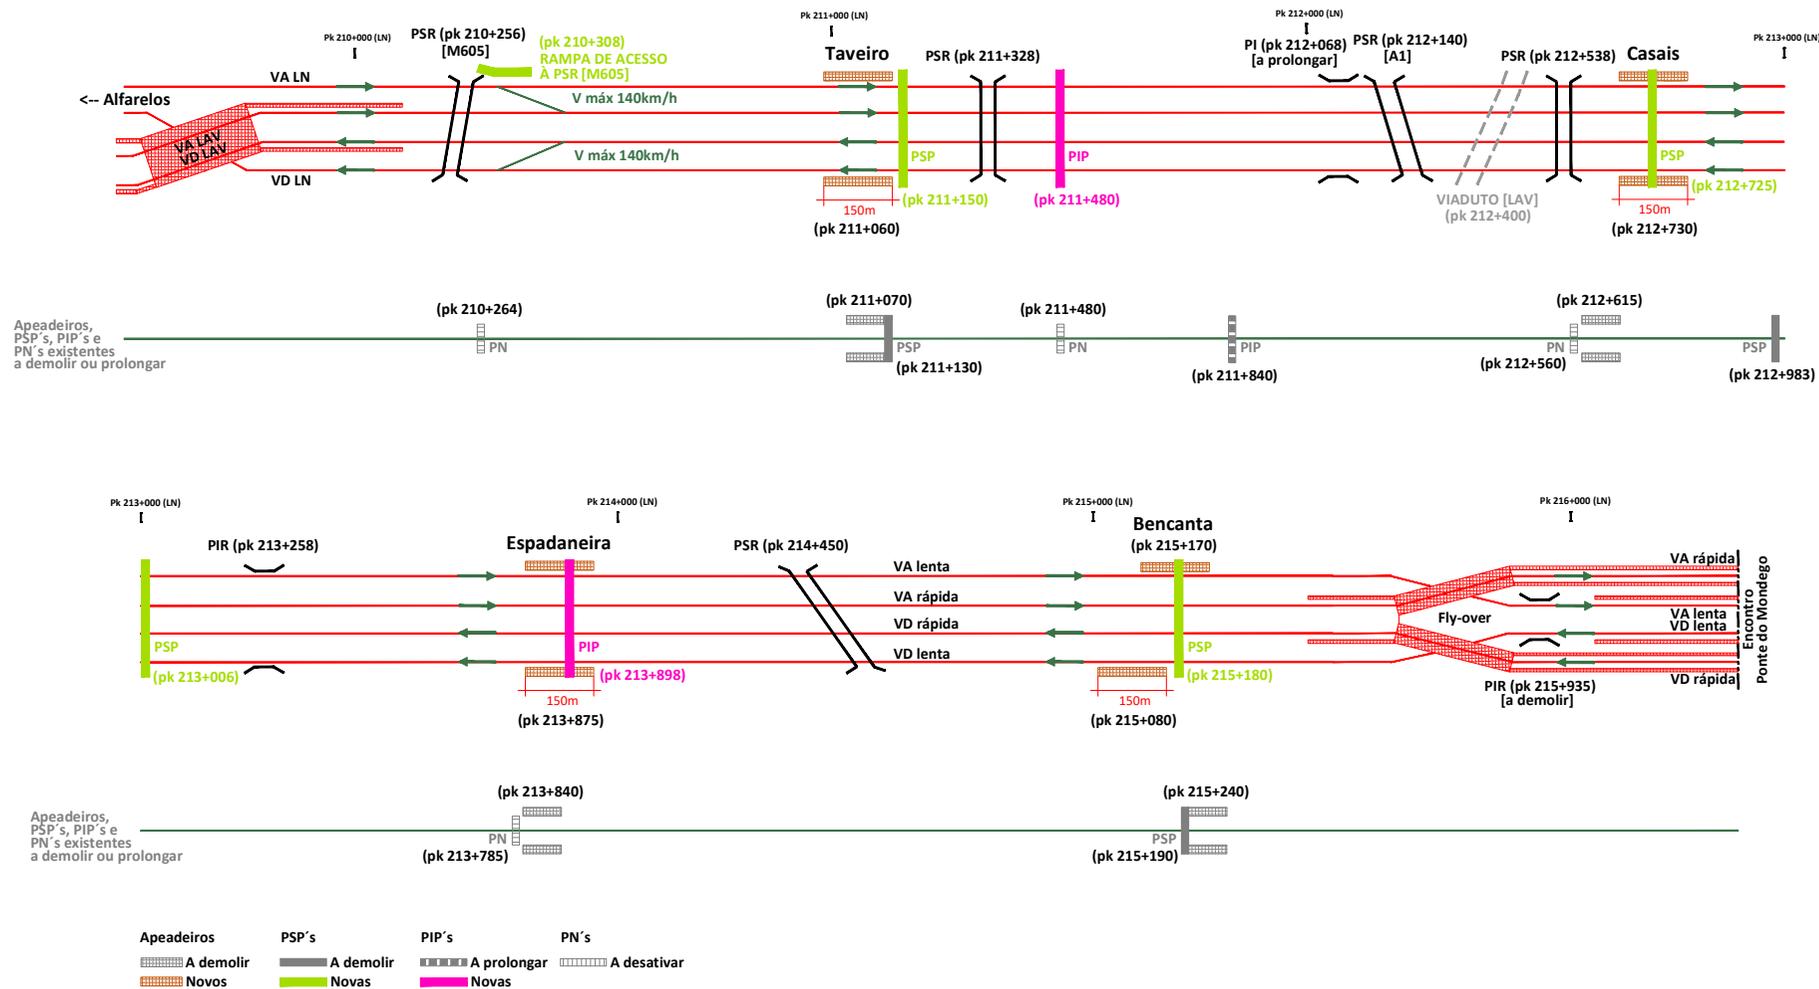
Esquema de Localização das Obras de Arte entre Taveiro e Bencanta
